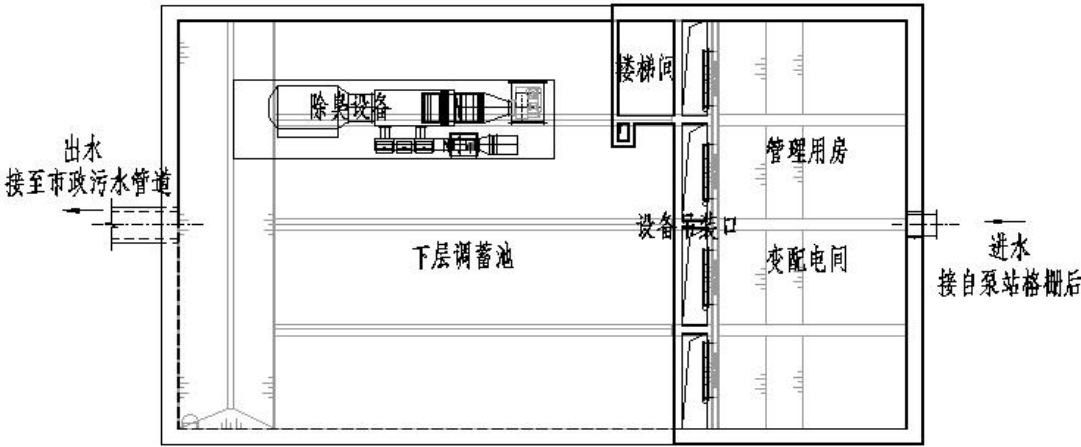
半地上式钢筋混凝土调蓄池平面示意图
